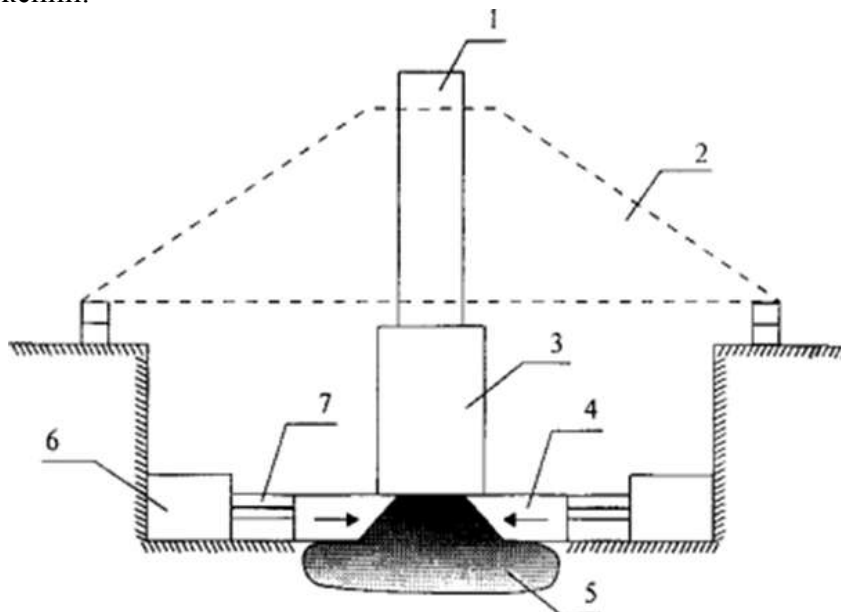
Усиление фундамента с обжатием основания элементами уширения: 1 - стена здания; 2 - разгружающие подкосы; 3 - существующий фундамент; 4 - железобетонные плиты уширения; 5 - обжатый фрагмент основания; 6 - упорные конструкции; 7 - домкраты
